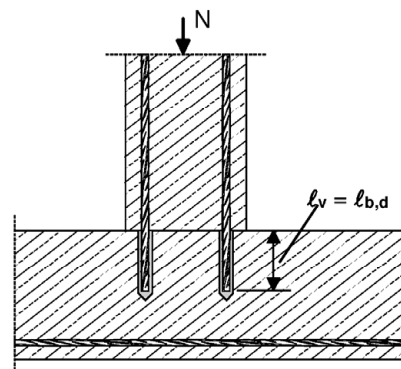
Bewehrungsanschlüsse überwiegend auf Druck beanspruchter Bauteile
